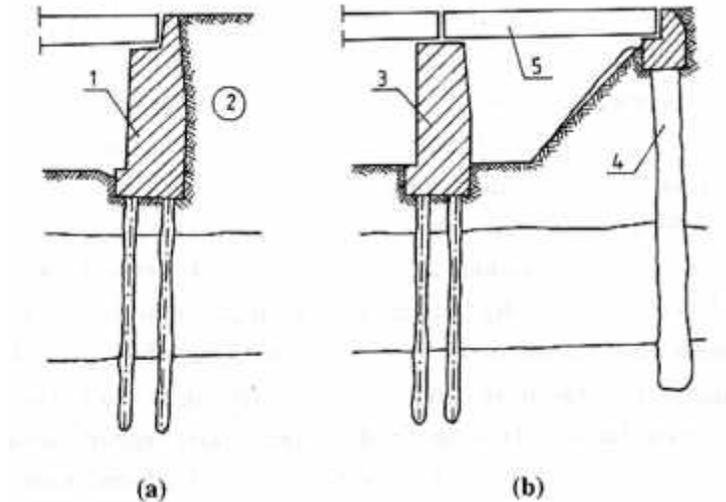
Mereduksi tekanan tanah, a). Stabilisasi tanah timbunan pada jalan pendekat, b). Dengan memasang konstruksi dinding penuh
